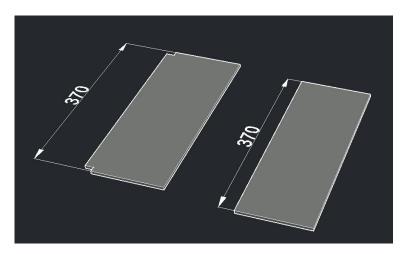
Losas utilizadas en el sector caja escala. Fuente: Elaboración propia.
